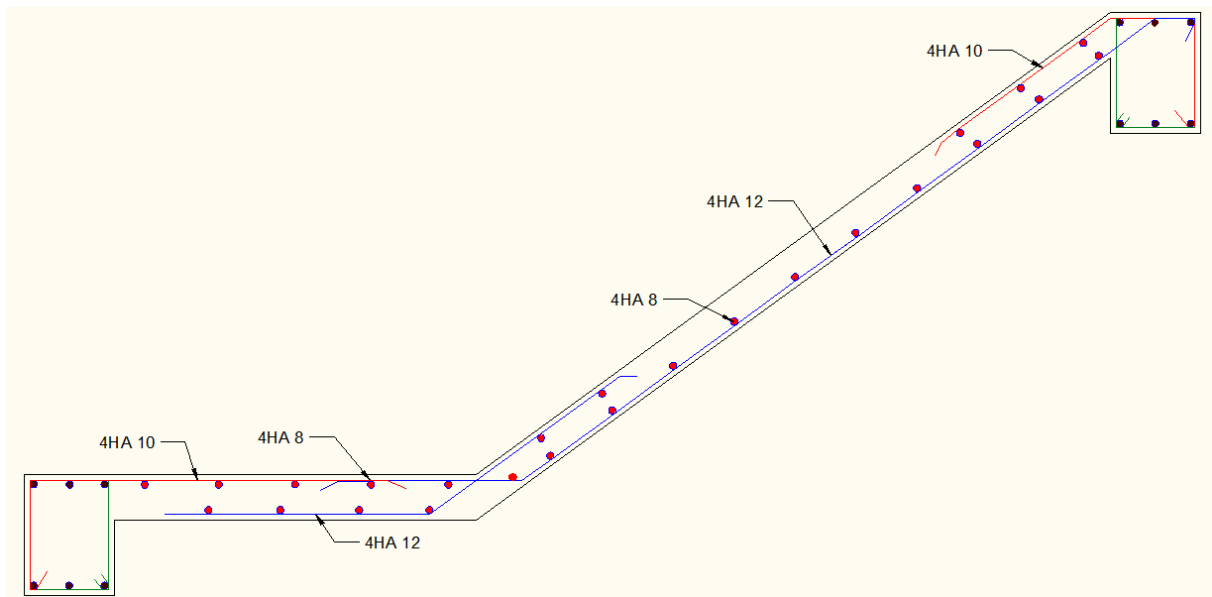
Schéma de ferrailage de l'escalier type 2.
